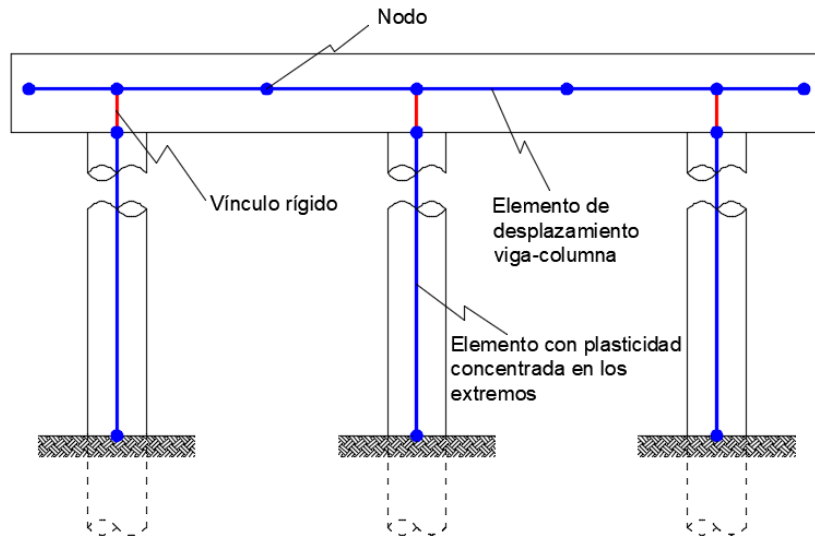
Discretización de pilas de múltiples columnas en puente de la clase VH-SATM.
